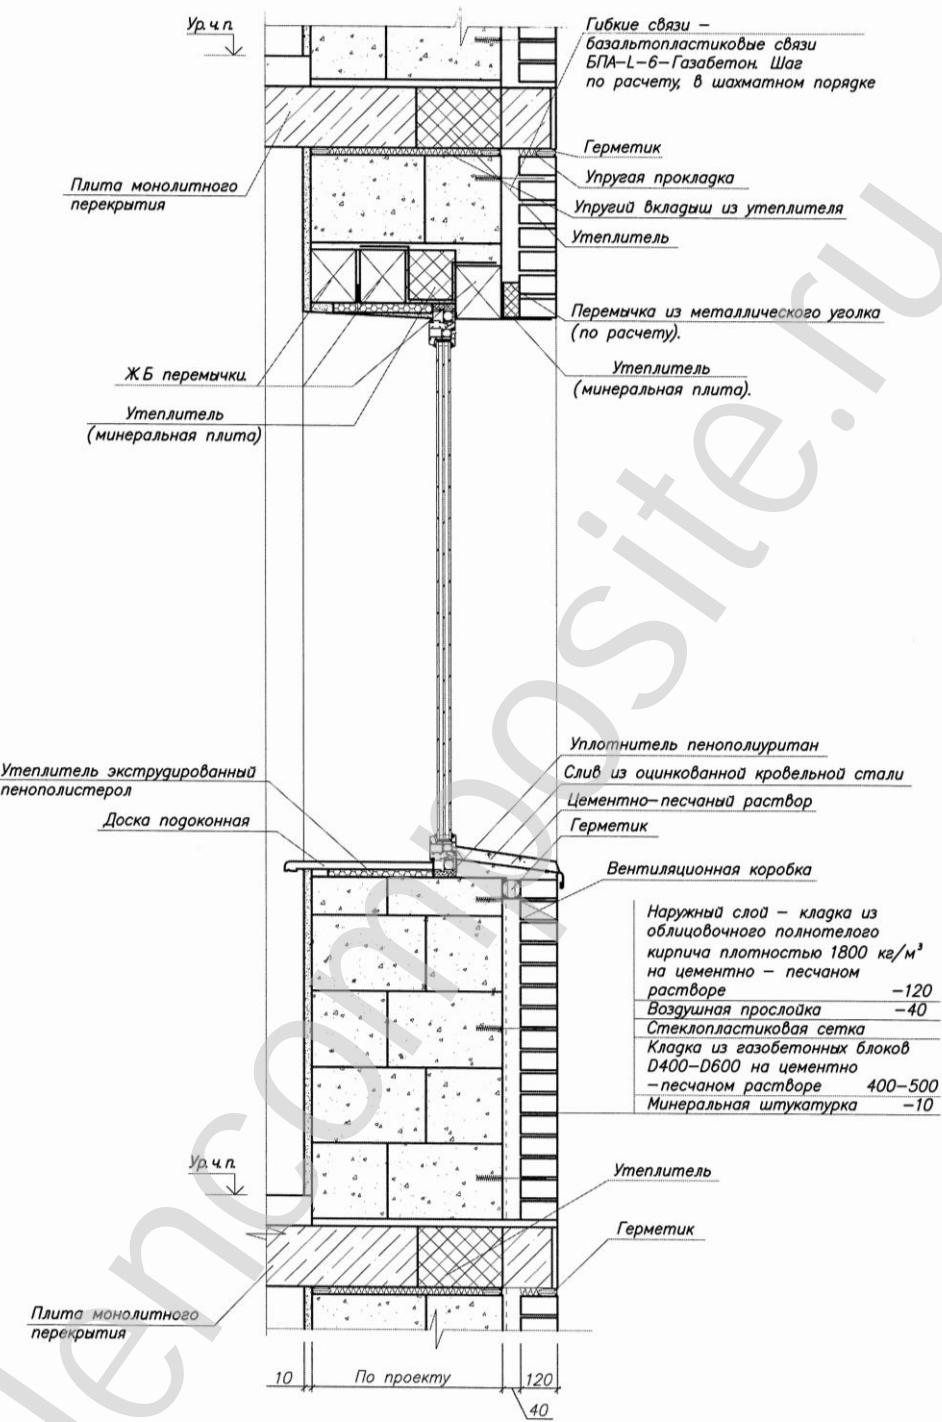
Поперечное сечение стены и схема расположения слоев с применением газобетона (оконный проем)
